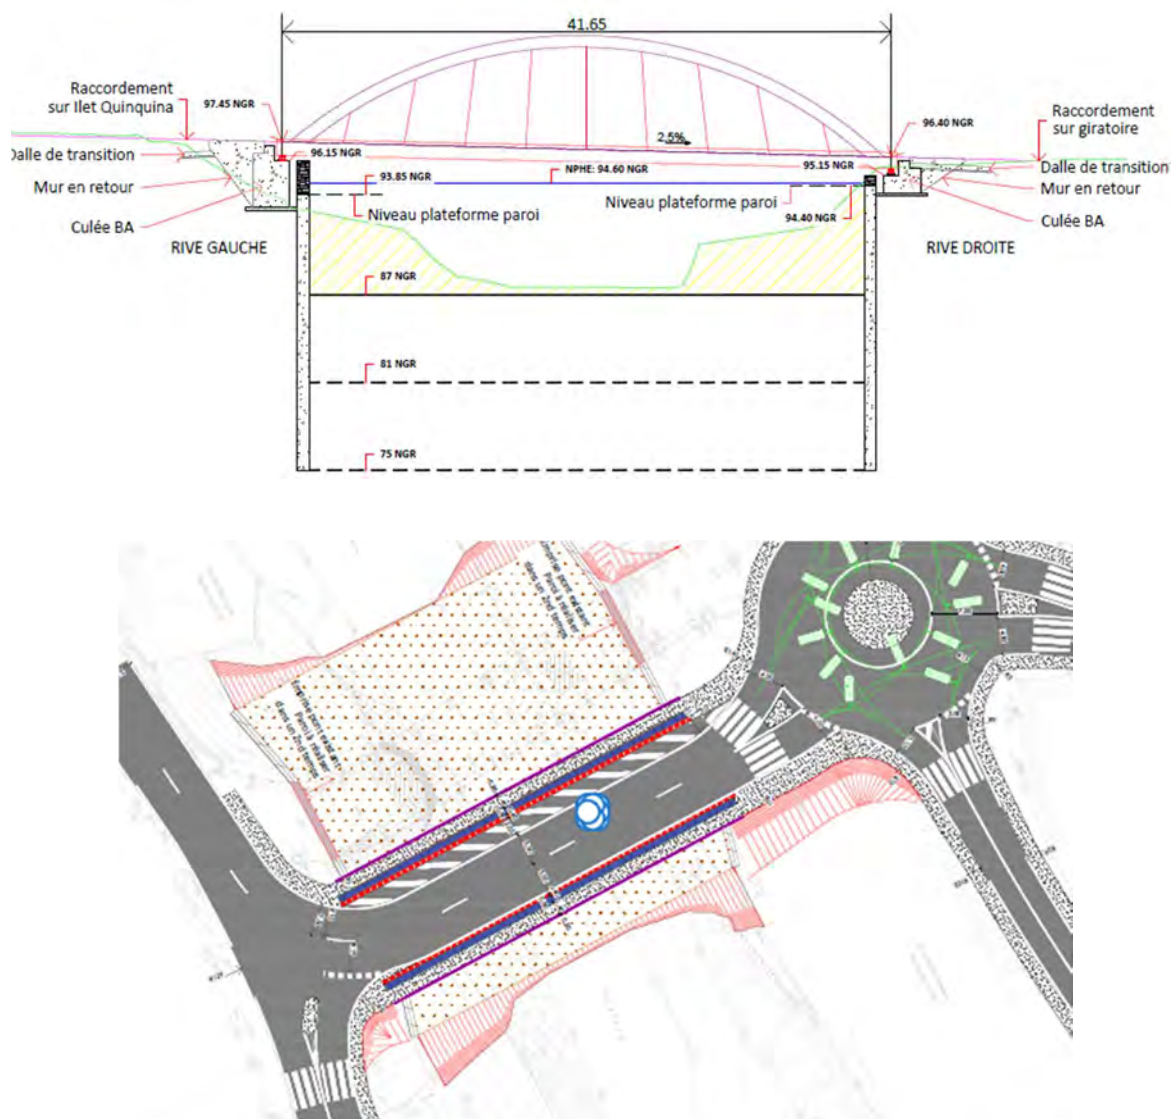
vues en coupe et en plan du nouveau pont Desbassyns (source : CINOR)
